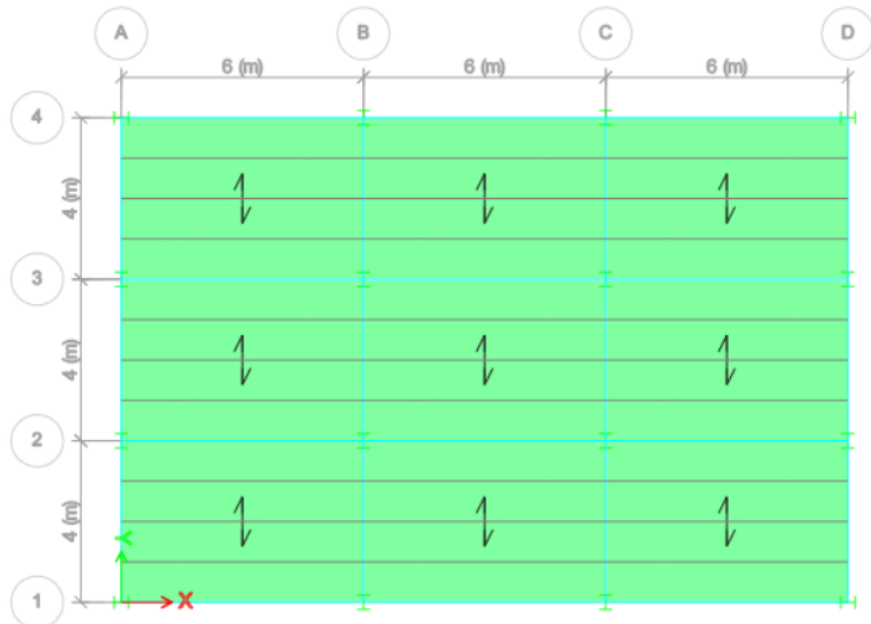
Vista en planta del Pórtico Arriostrado Concéntricamente.
